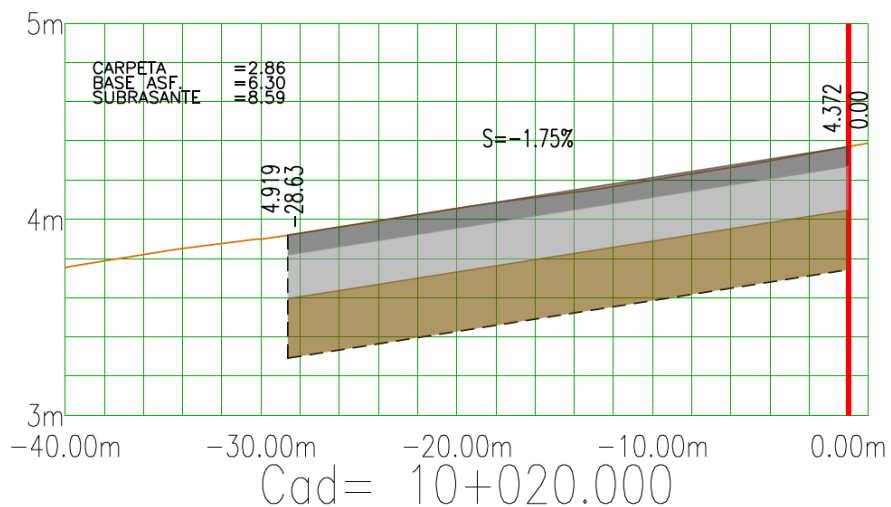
Sección de construcción 10+020 de la Plataforma 08¹⁴.
